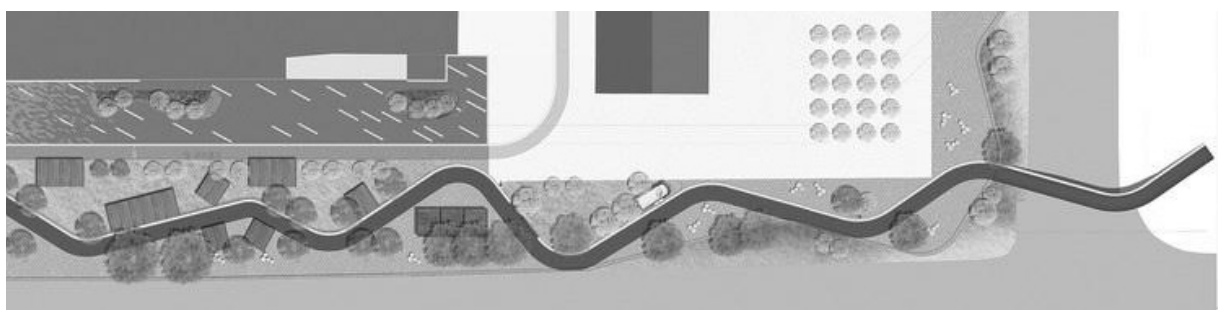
Схема генплана. Реконструкция набережной Минханг / SPARK Architects
